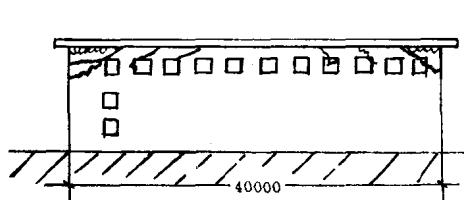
钢筋混凝土屋盖的膨胀裂缝
